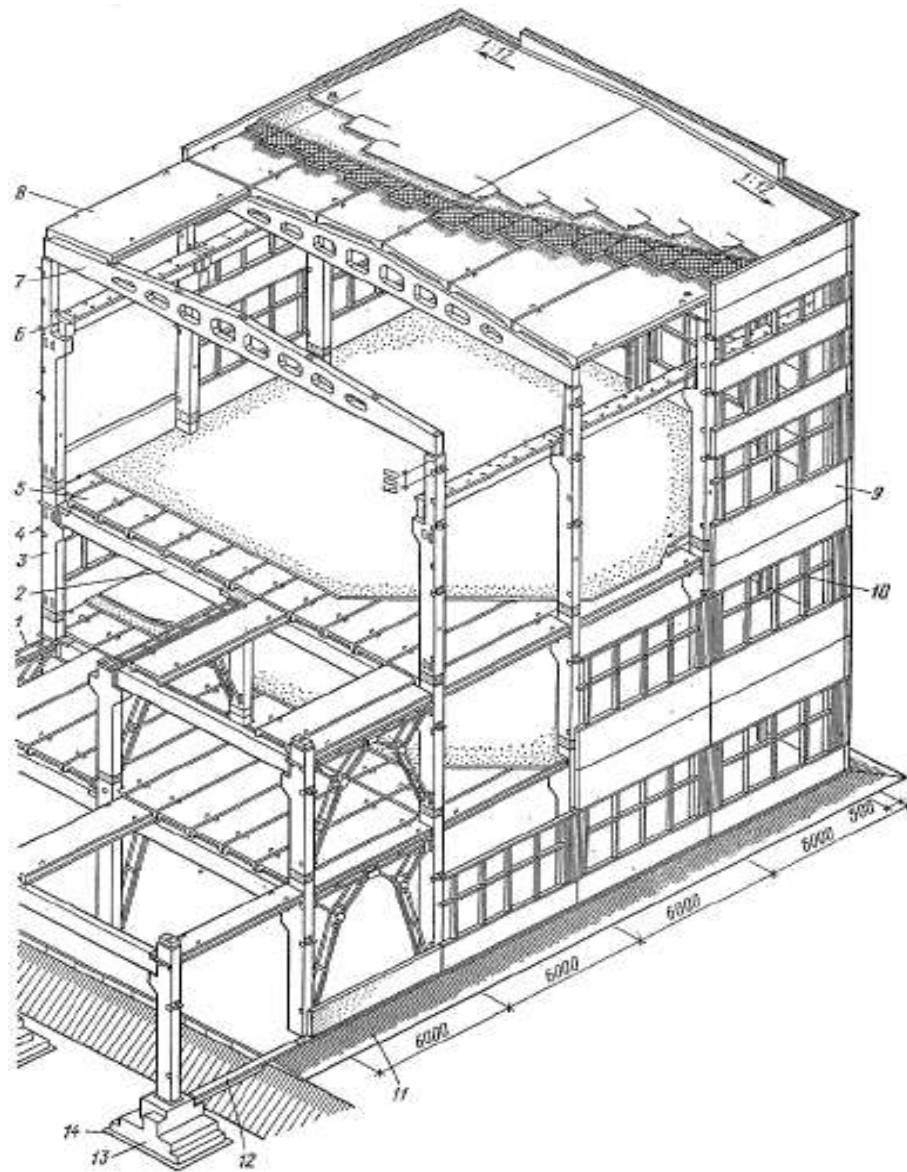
Основні конструкції та елементи багатоповерхової будівлі каркасно-панельної будівельної системи: 1 – вертикальний зв’язок між колонами; 2 – ригель; 3 – колона; 4 – монтажний столик для спирання стінових панелей; 5 – залізобетонна ребриста плита перекриття; 6 – залізобетонна підкранова балка; 7 – залізобетонна балка покриття; 8 – залізобетонна плита покриття; 9 – стінова панель; 10 – віконне скління; 11 – вимощення; 12 – фундаментна балка; 13 – бетонний стовпчик для спирання фундаментної балки; 14 – стовповий фундамент під колону
